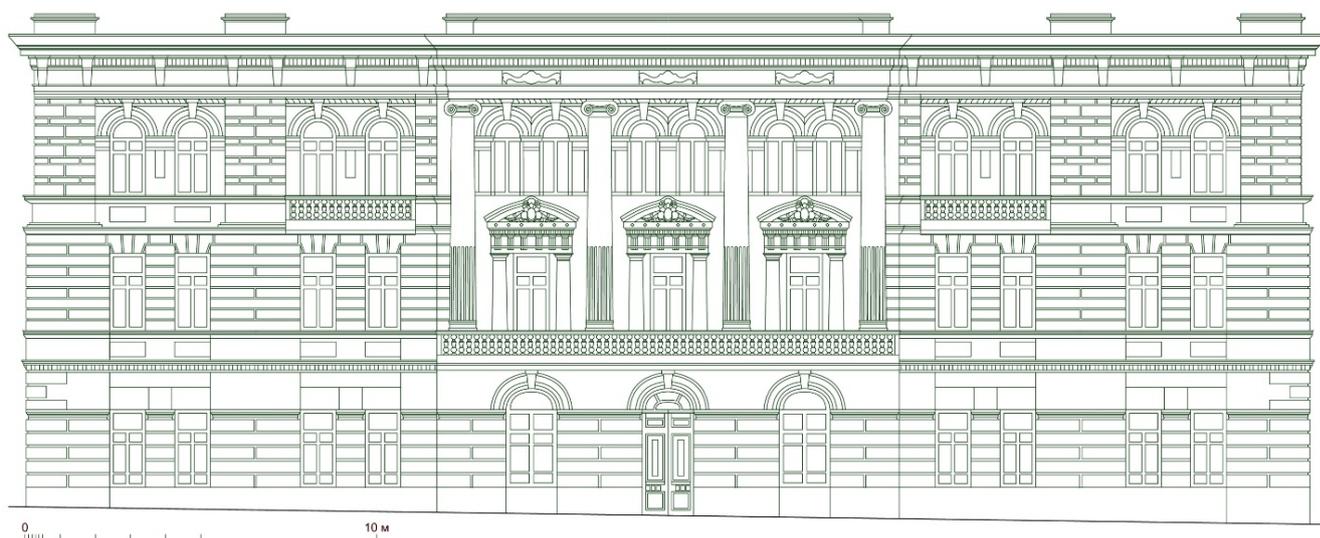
Здание дома Я. Л. Семенова, фасад со стороны ул. Светланской
